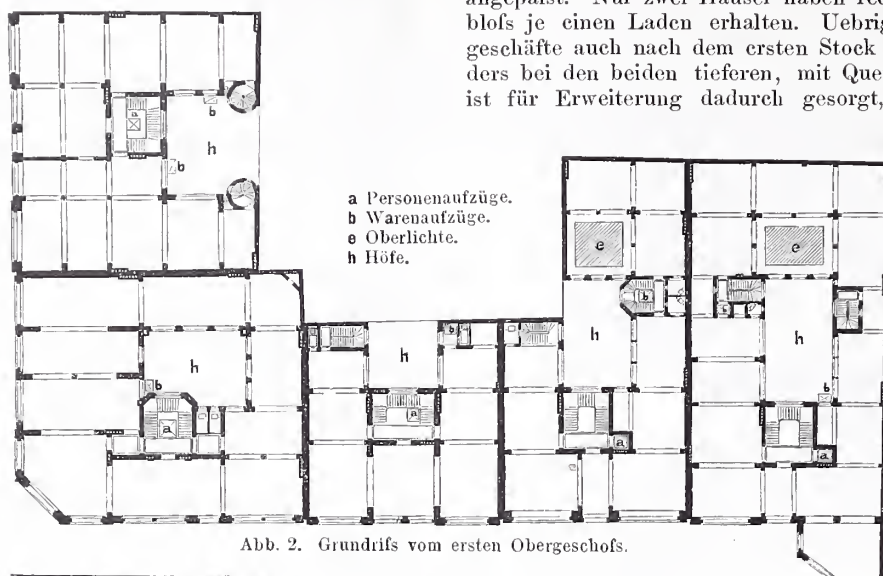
Grundriss vom ersten Obergeschoss.
